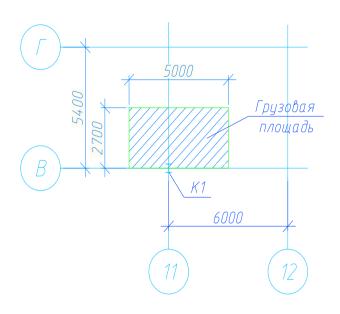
Грузовая площадь колонны К1 от перекрытия
